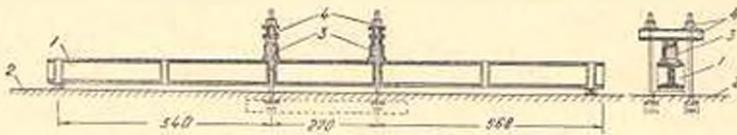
Схема испытания струнотонной балки на изгиб на стенде; 1—струнотонная балка; 2—силовая плита; 3—гидродомкраты; 4—тяги с траверсами.
